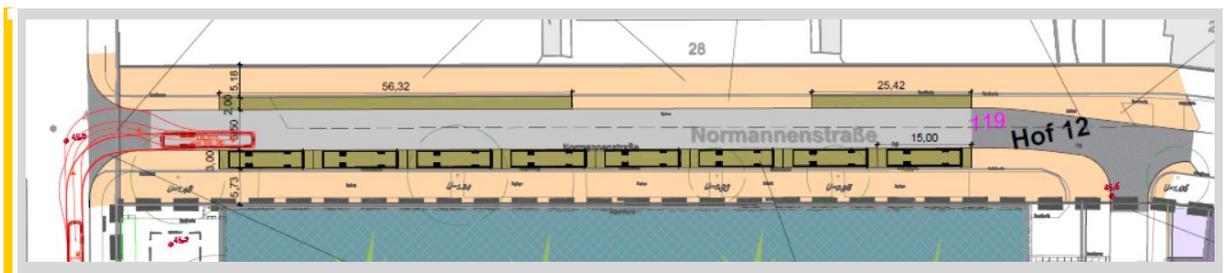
Gestalterische Vorschläge Normannenstraße (Ausschnitt Lageplan)
